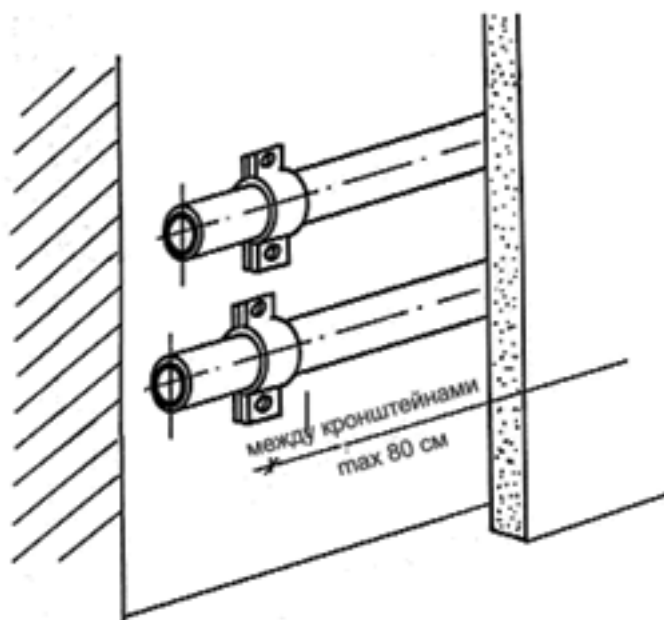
Открытая прокладка труб за гипсокартонными плитами.
